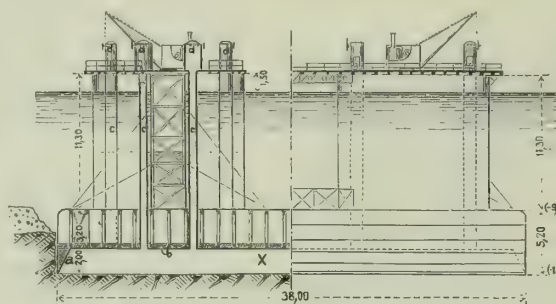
Schnitt und Ansicht in der Längsrichtung des Senkkastens.
